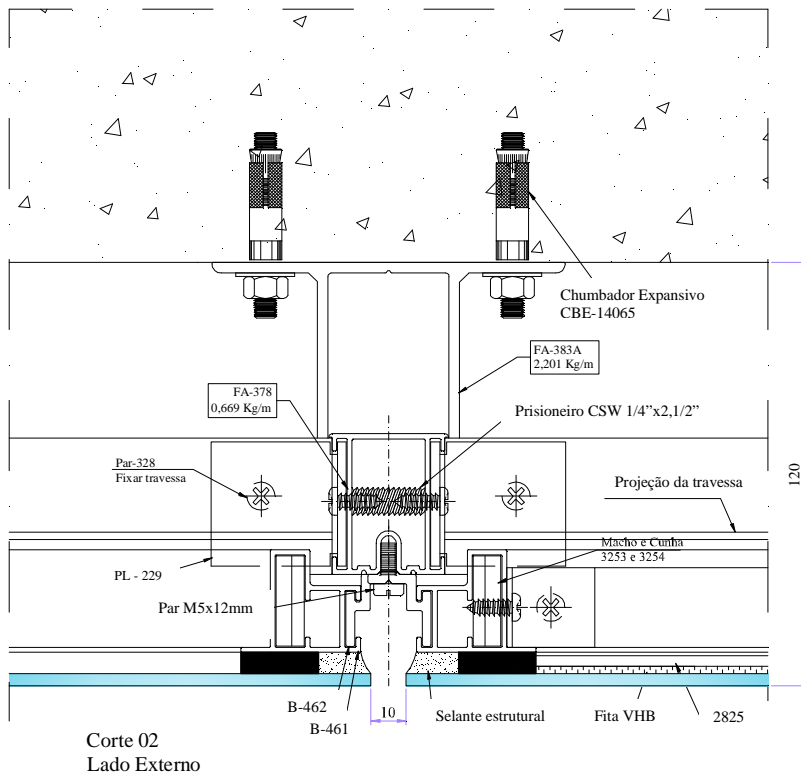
Corte 02: Corte horizontal com detalhes do sistema construtivo. Cotas em mm.
